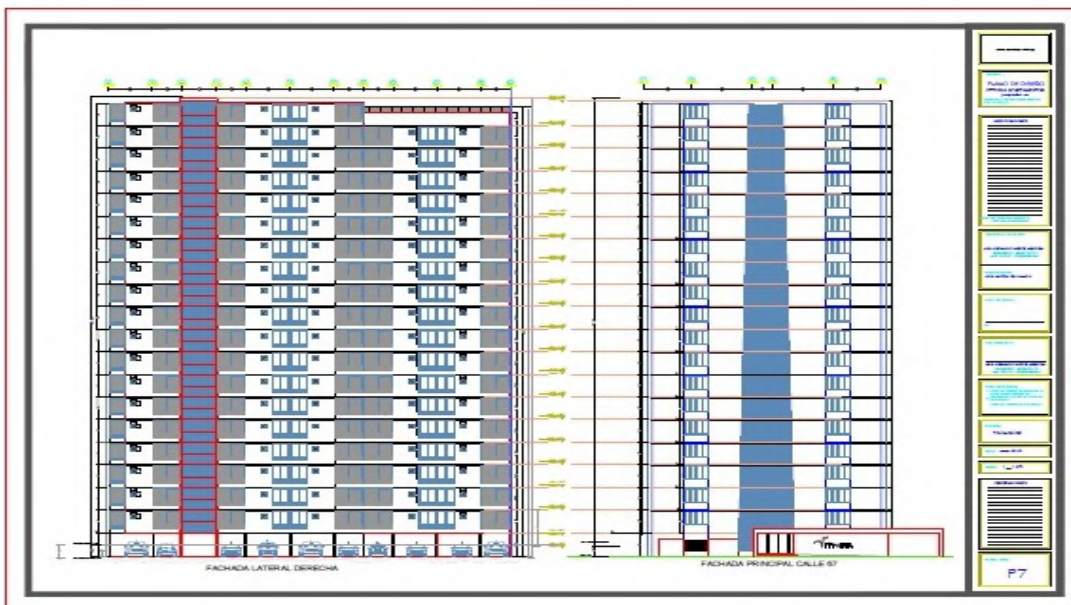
Plano planta primer pisos y fachada. Fuente: Solicitante.
